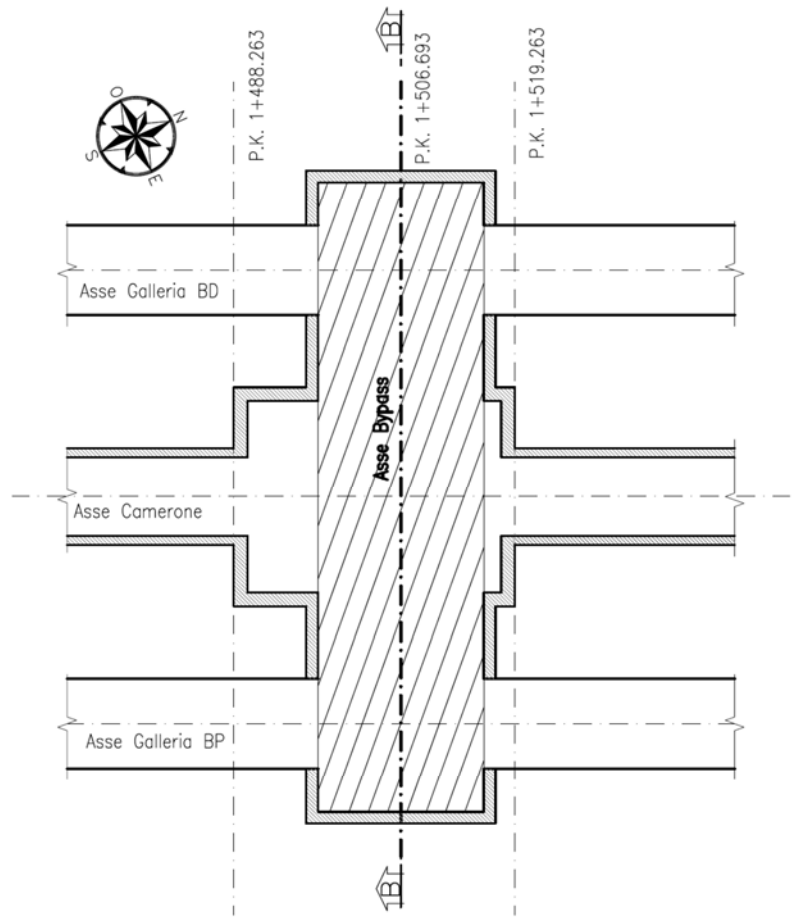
Camerone smontaggio TBM, fase 6, profilo longitudinale, planimetria, layout in pianta.
